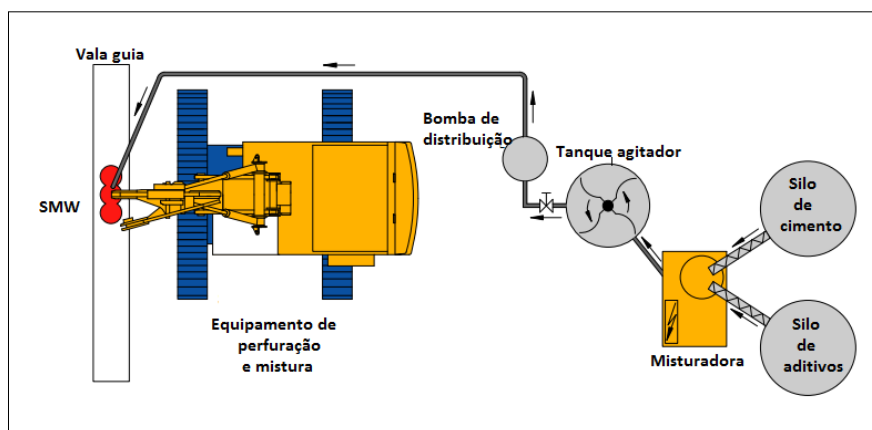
Esquema da instalação do equipamento DSM (adaptado de Bauer, 2010)
